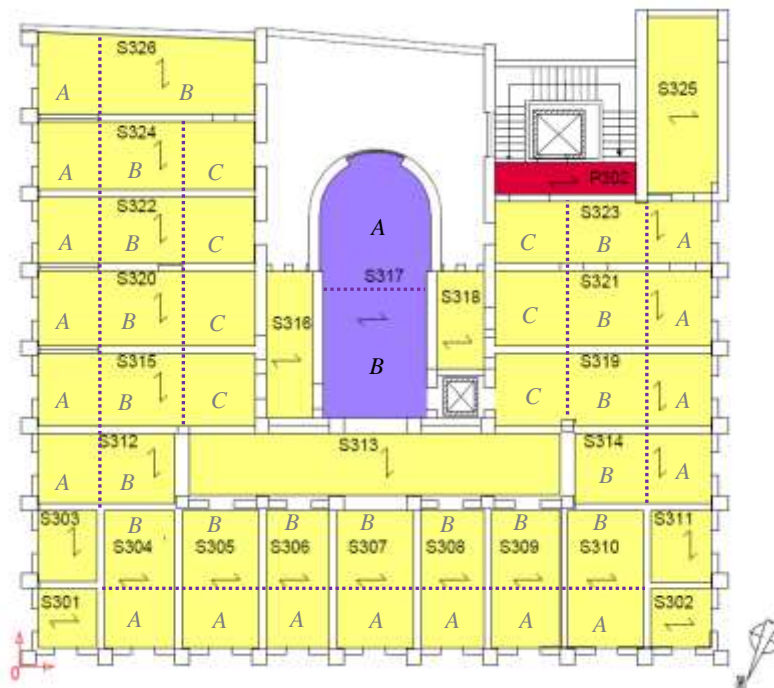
Pianta chiave dei solai; quarto orizzontamento.
